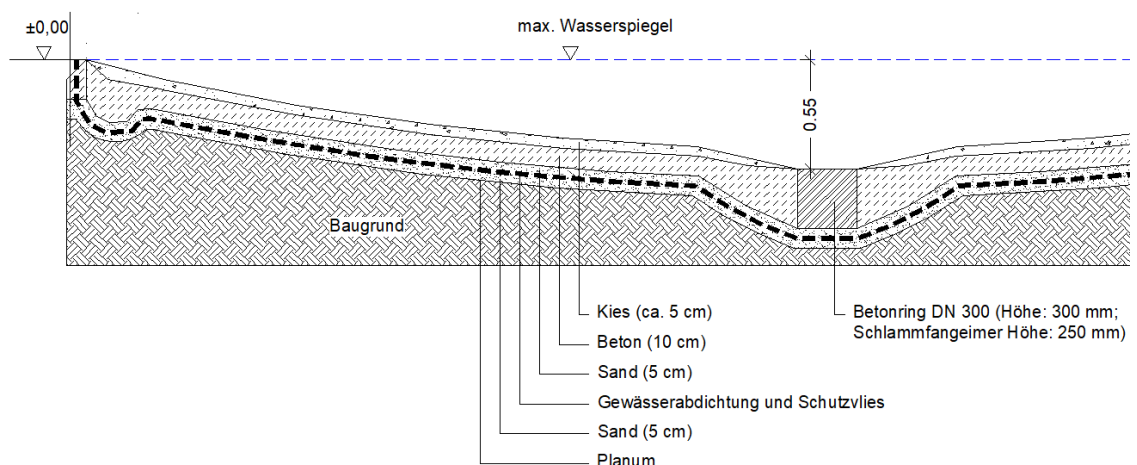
Regelquerschnitt Laichgewässer mit Folien-/Betondichtung
